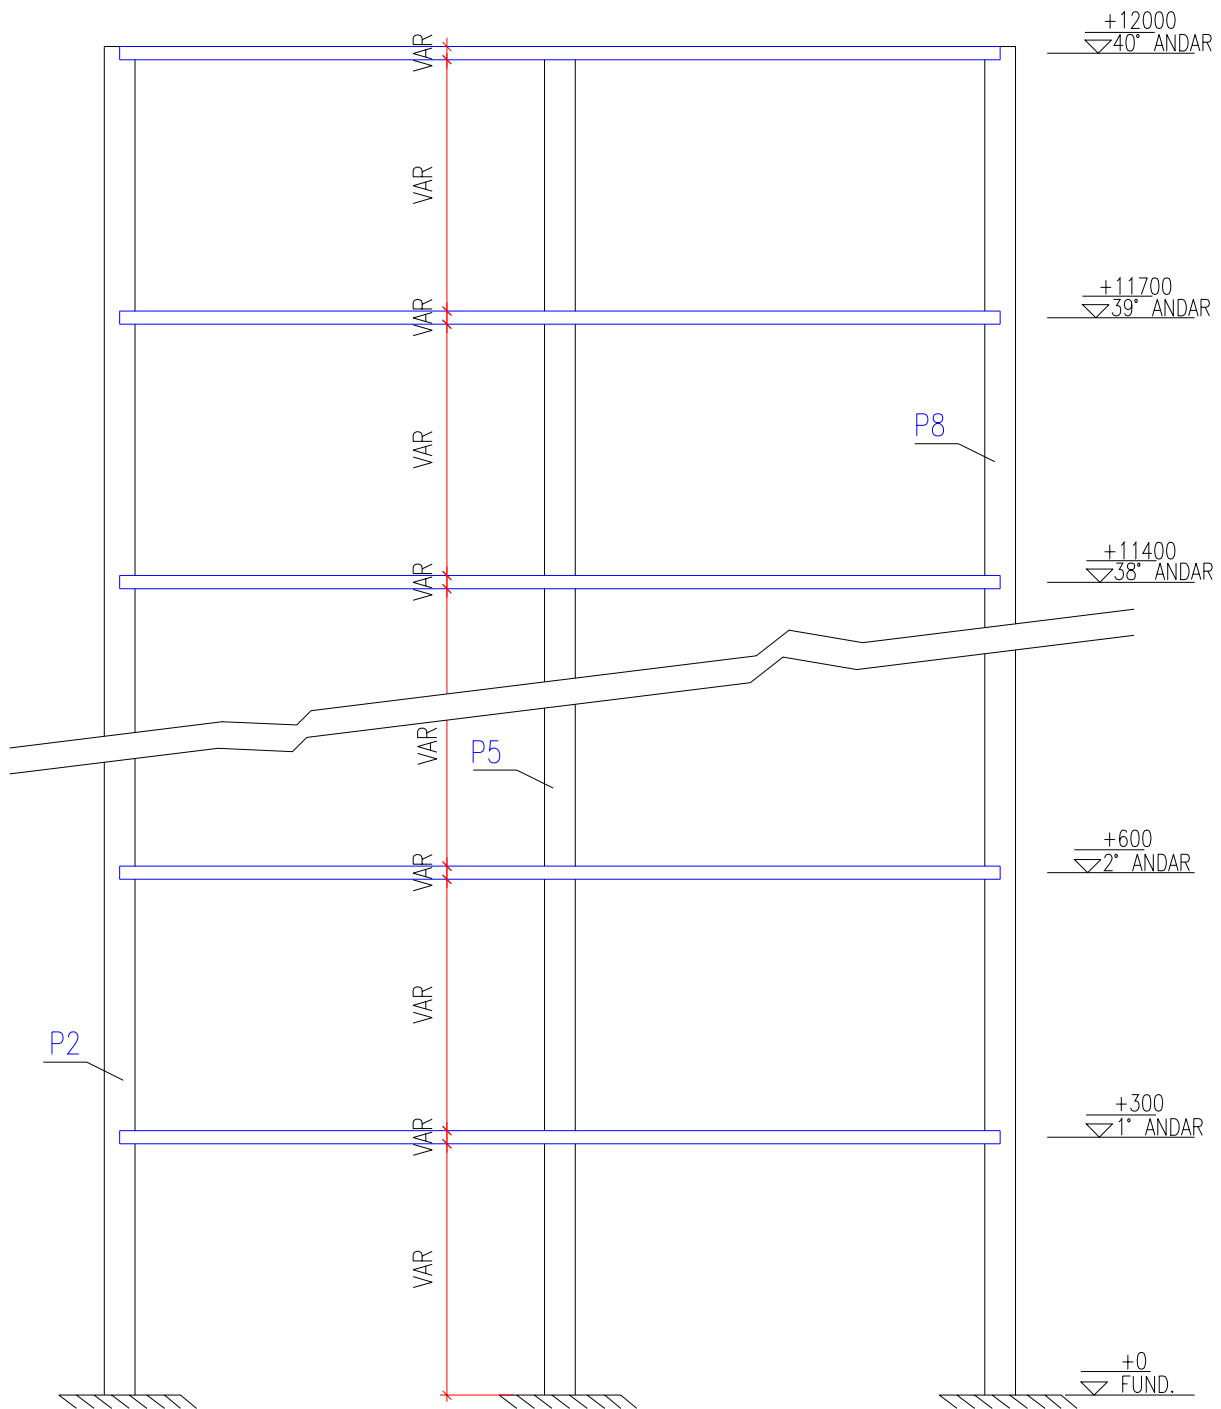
Corte A-A da estrutura (níveis em centímetros)
